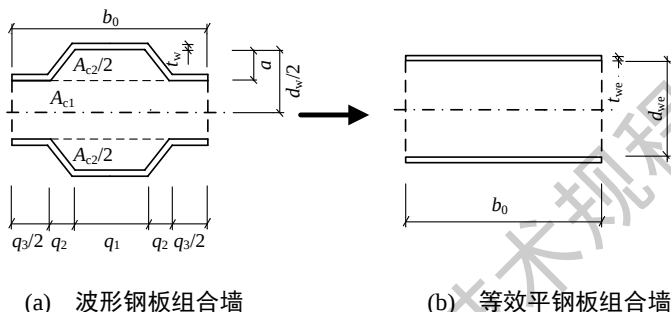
波形钢板混凝土组合墙的刚度等效
